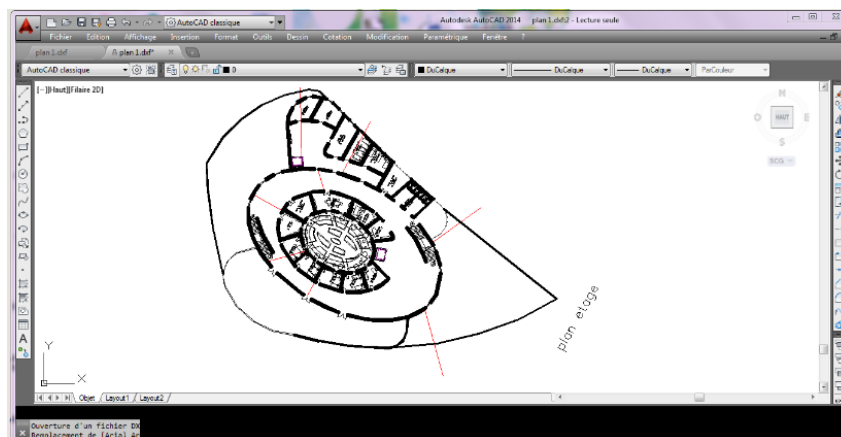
plan 1ère étage source : Autocad 2014
